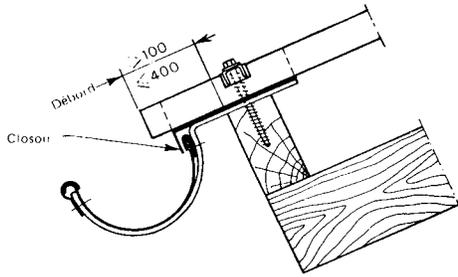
Egout - Gouttière pendante avec pièce rapportée formant larmier - Fixations sur crochets et interposition d'un closoir à bord nervuré soudé - Coupe verticale
